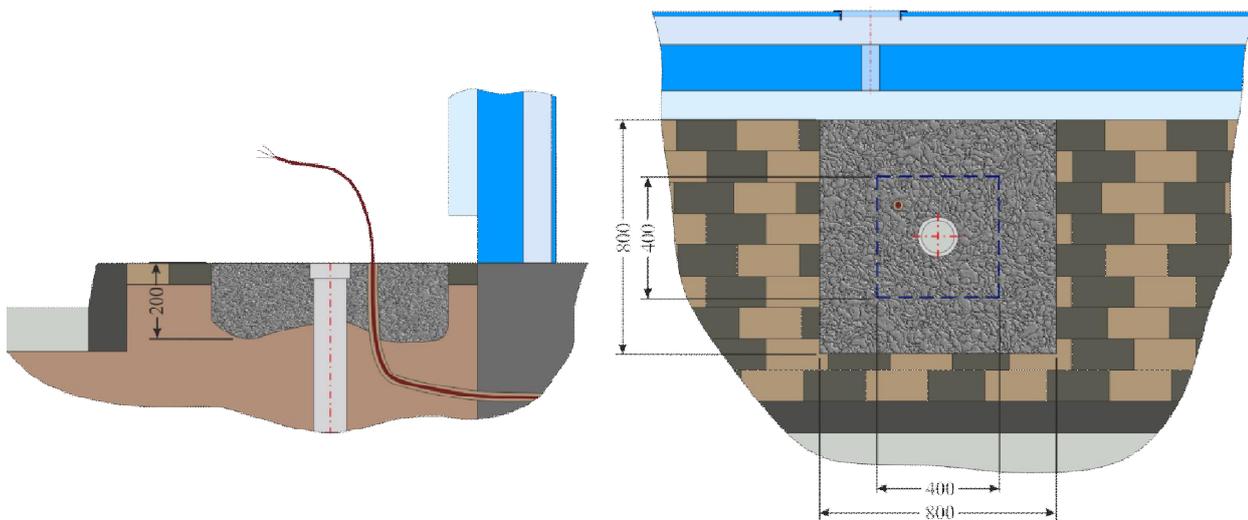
Схема заливки в фундамент дренажной трубы и кабеля электрического питания термобокса
